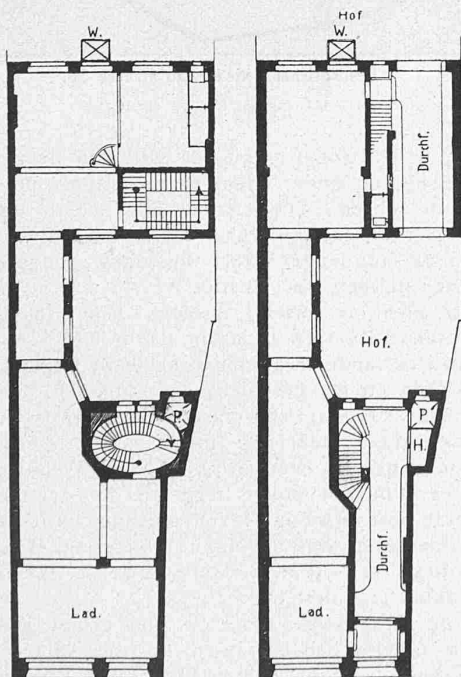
u. 10. I. Obergeschoss. 1:400. Erdgeschoss.
